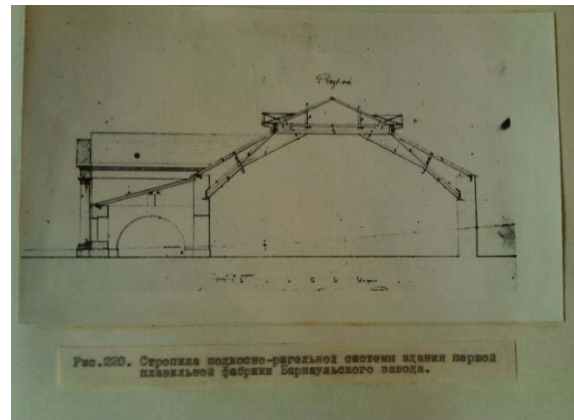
Конструктивная схема стропил подковоно-ригельной системы здания первой серебряноплавильной фабрики
